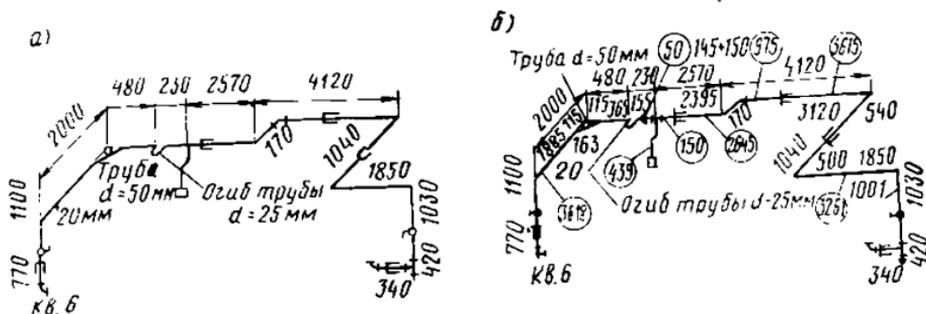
Образец замерной схемы на внутренний газопровод
